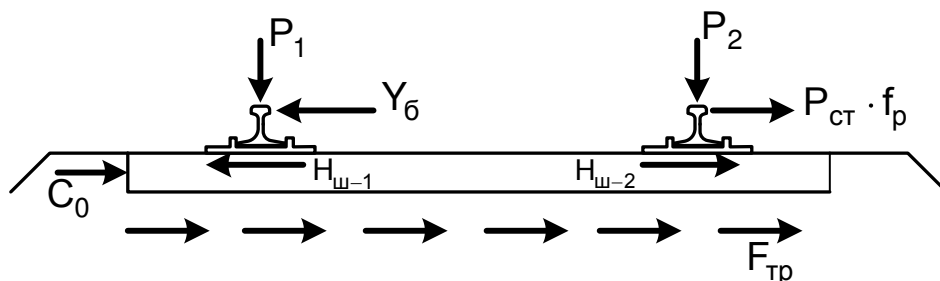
Расчетная схема для определения поперечной устойчивости пути
